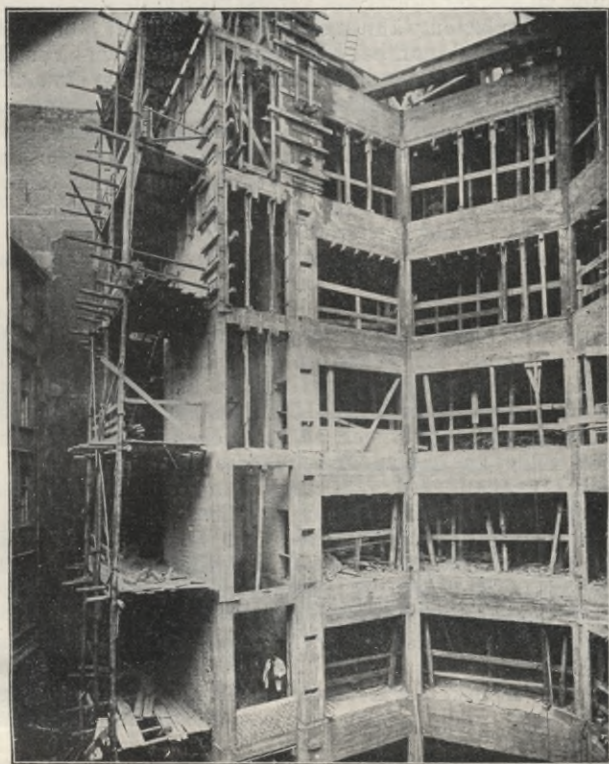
Eisenbetongebäude nach teilweiser Ausschaltung.
